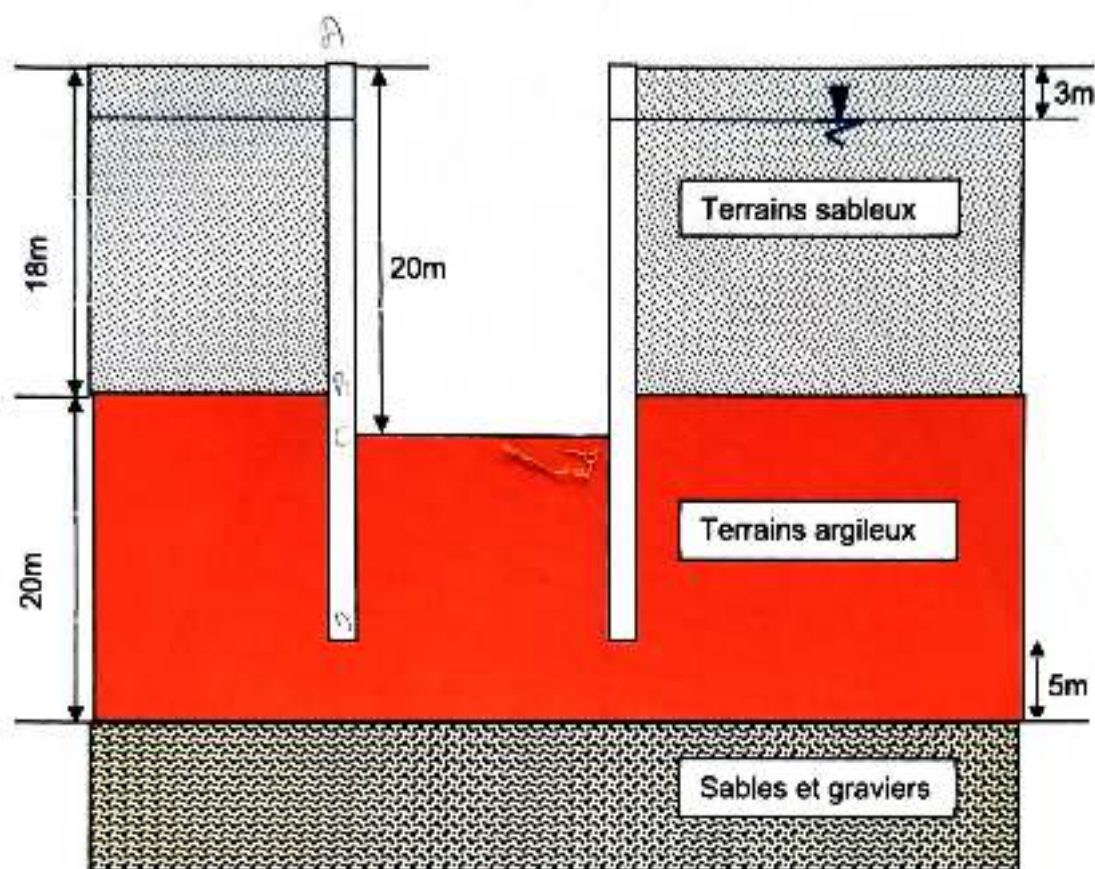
Coupe géotechnique du site et dimensions de l'ouvrage à construire
